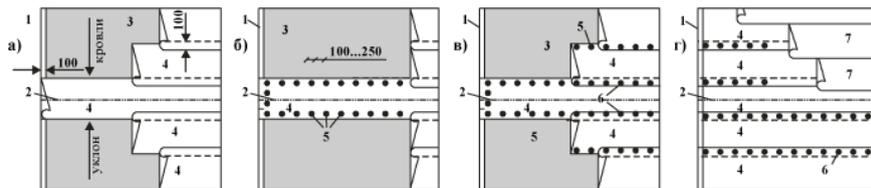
Укладання покрівельного килима без приклеювання до основи механічним способом
